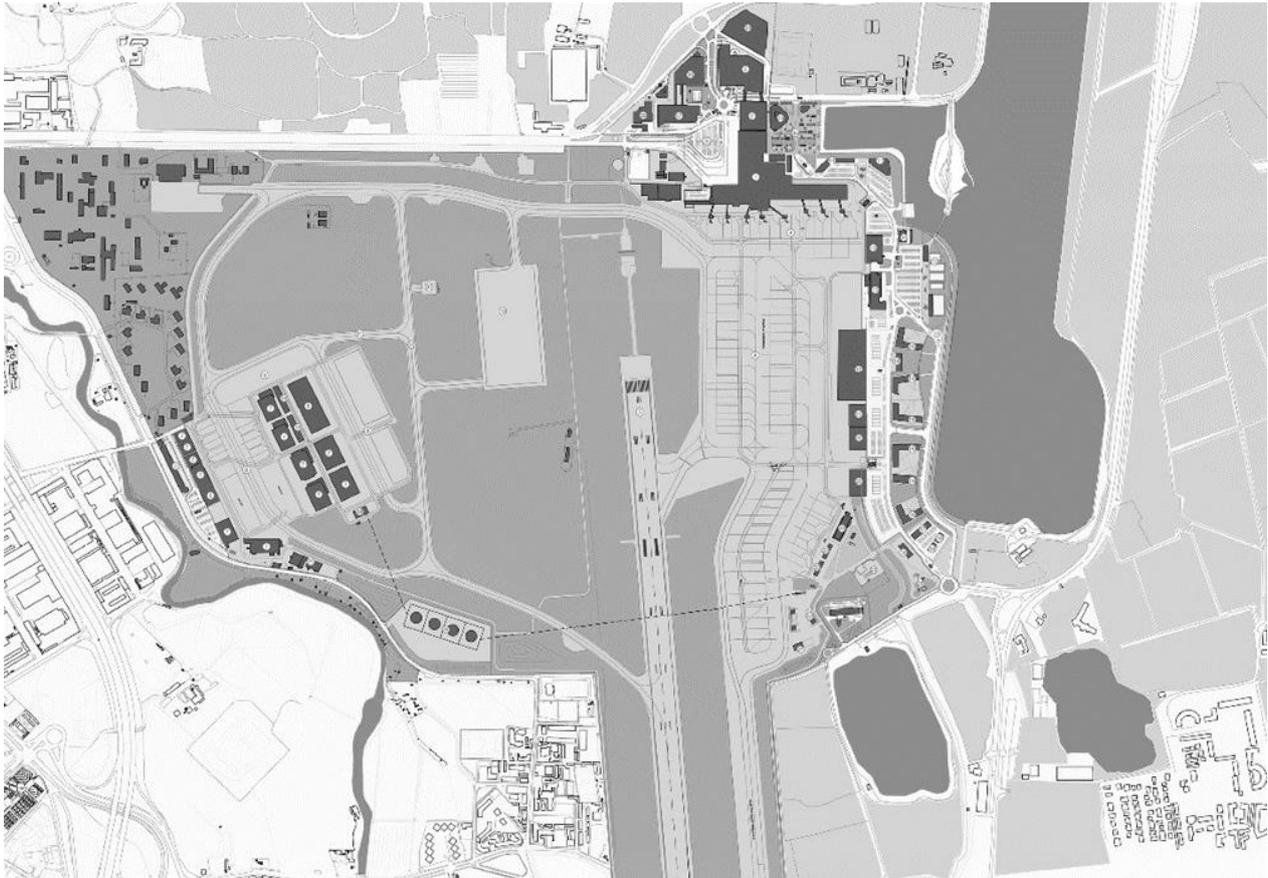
Configurazione finale dell'aeroporto di Milano Linate secondo l'assetto individuato dal Masterplan (Stralcio tavola SIA QPGT\_T03)
